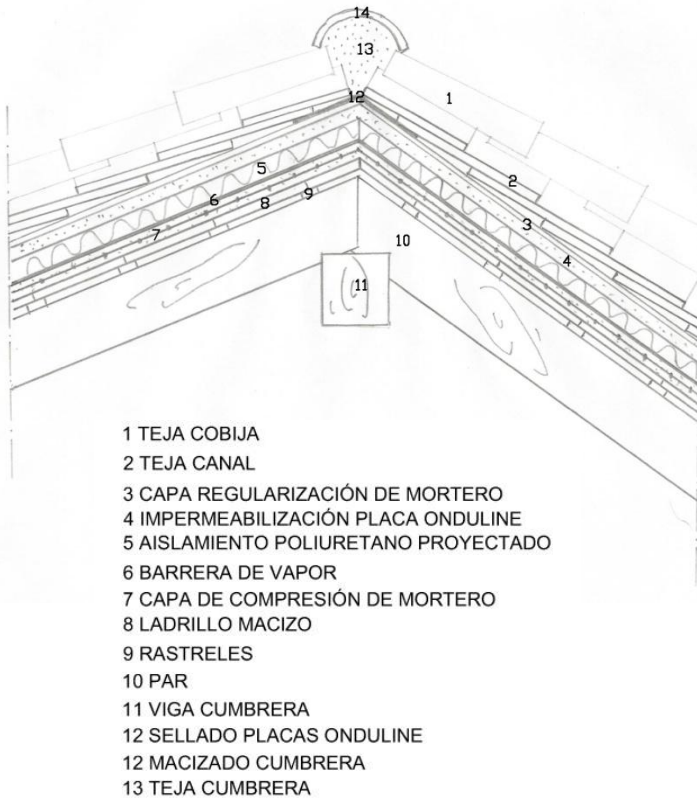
Detalle constructivo reforma cumbrera cubierta. 2016. Propia.
